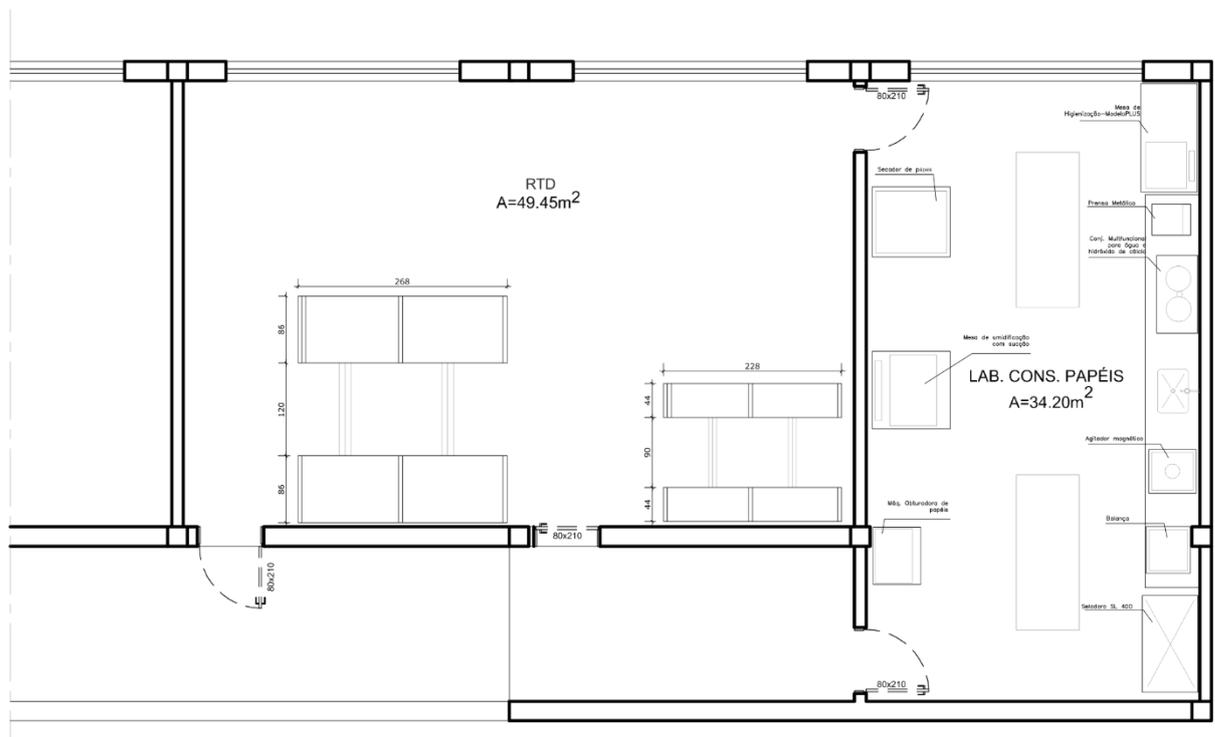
Planta Baixa da RTD e do LaCRAP (Realizada por Adriano Reis)
